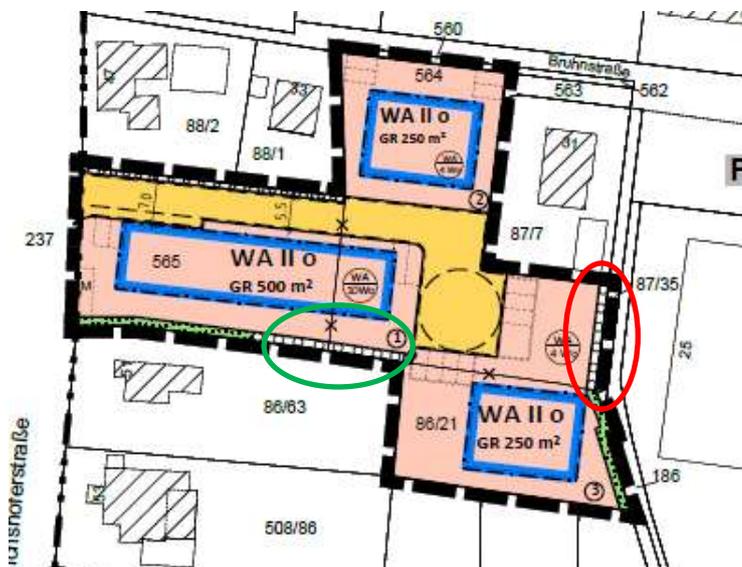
Ausschnitt der Planzeichnung zur 9. Vorhabenbezogenen Änderung, BP Nr. 9
